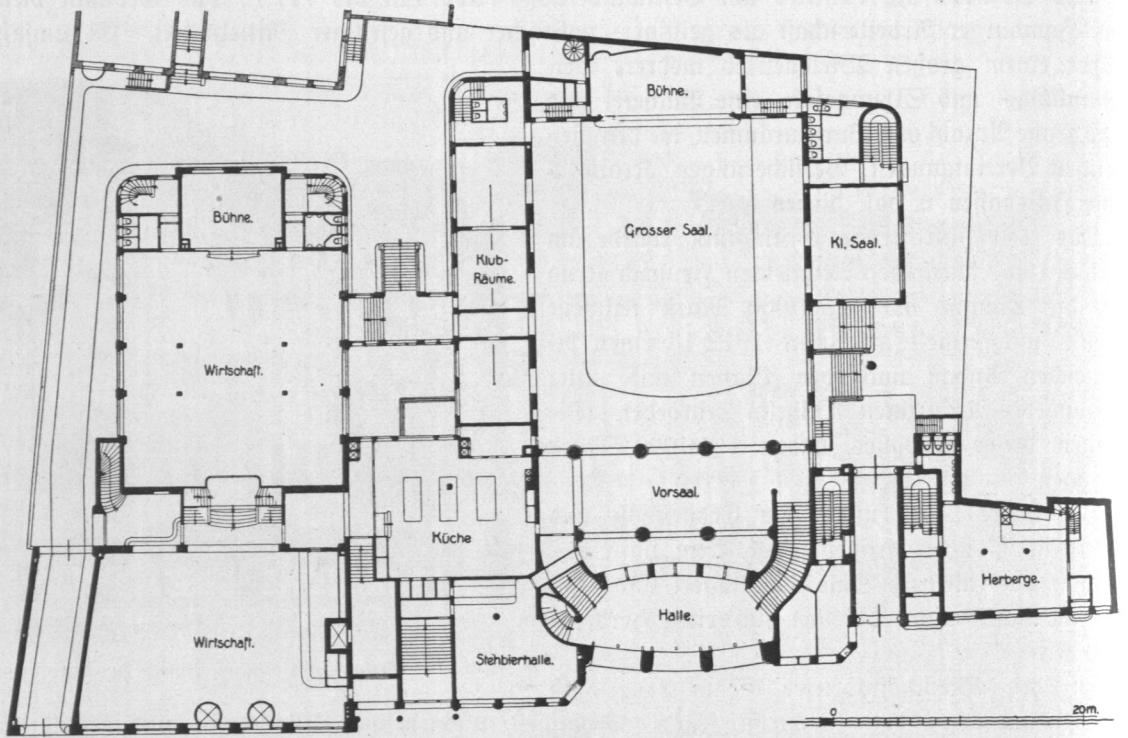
Gewerkschaftshaus, Erdgeschoss, Grundriß.
